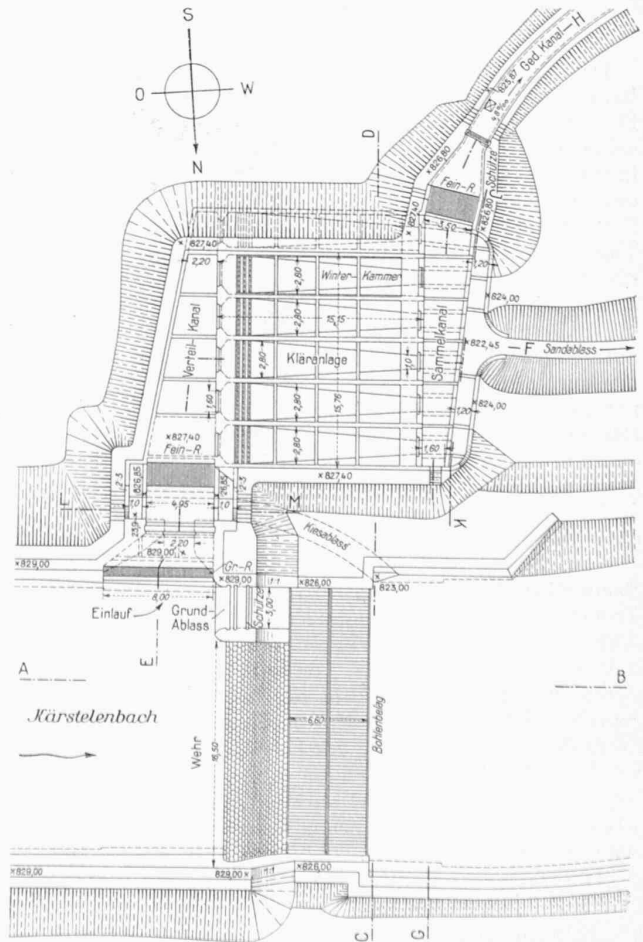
Fassung des Kärstelenbaches samt Kläranlage. — Grundriss 1 : 500.
